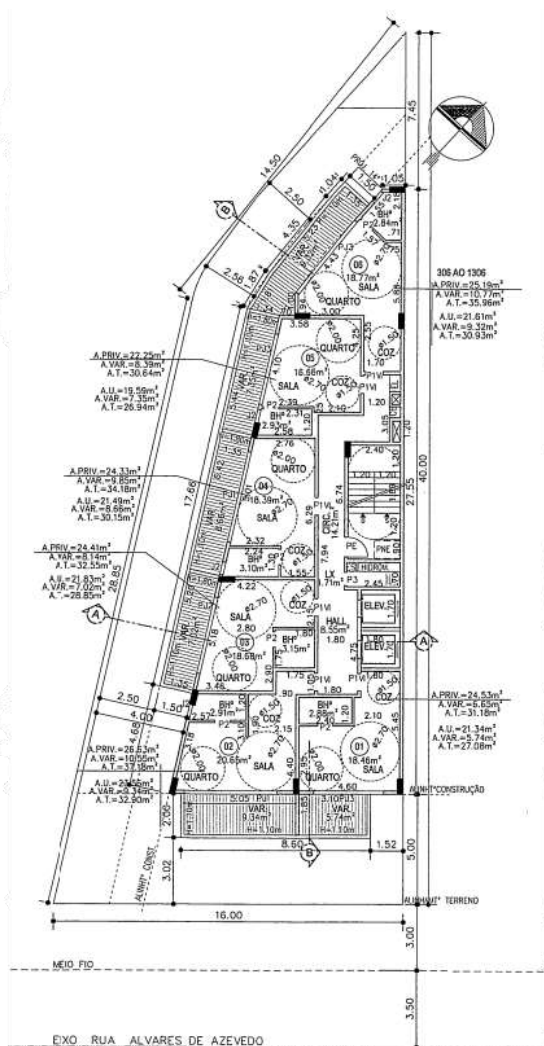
Pavimento Tipo (3º ao 13º andar) - Fonte: Projeto Legal
